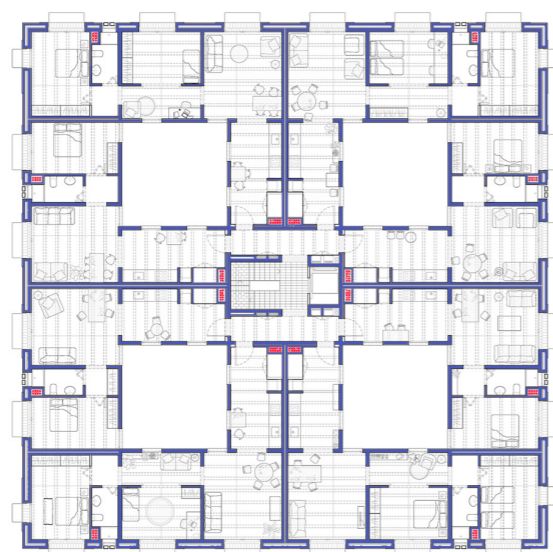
Planta tipo con instalaciones y muros rígidos.
